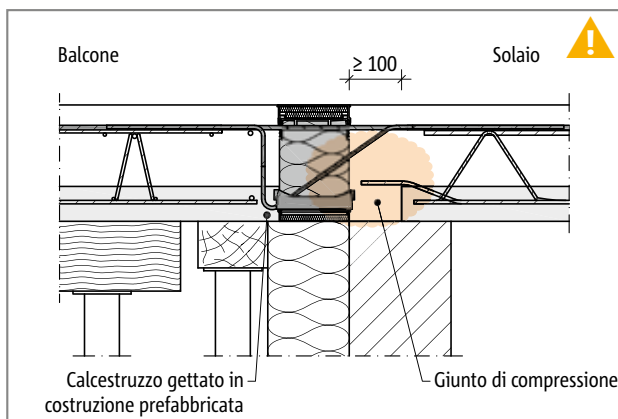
Schöck Isokorb® XT tipo KL: appoggio diretto, montaggio con piastre prefabbricate (qui: $h \leq 180$ mm), giunto di compressione lato solaio
